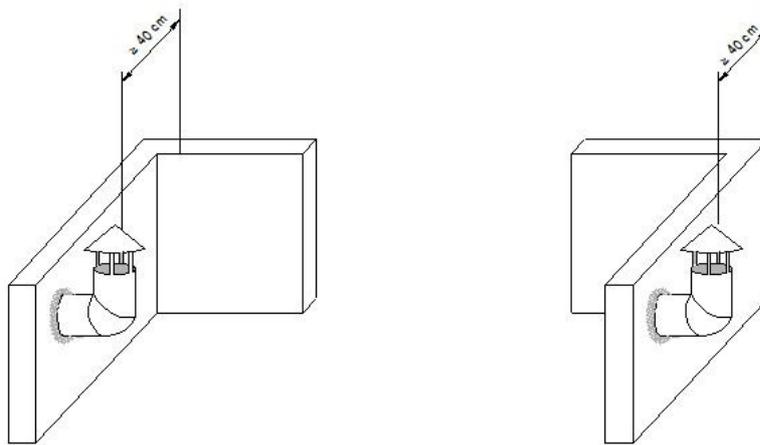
Terminal com afastamento horizontal mínimo de 0,40m de cantos e paredes.
